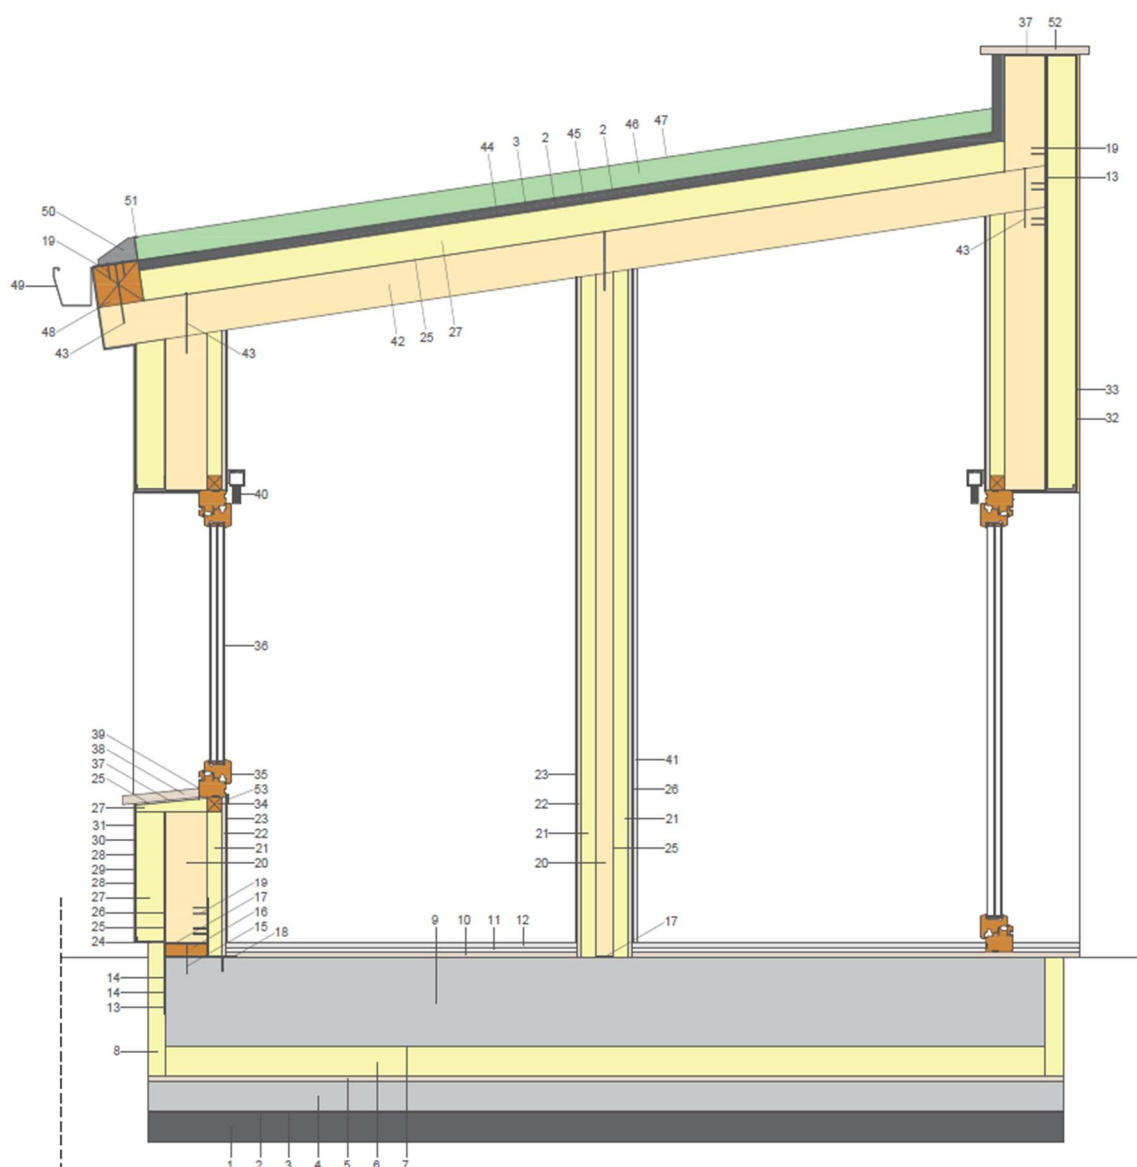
Sección constructiva general. 2025. Fuente: Elaboración propia
